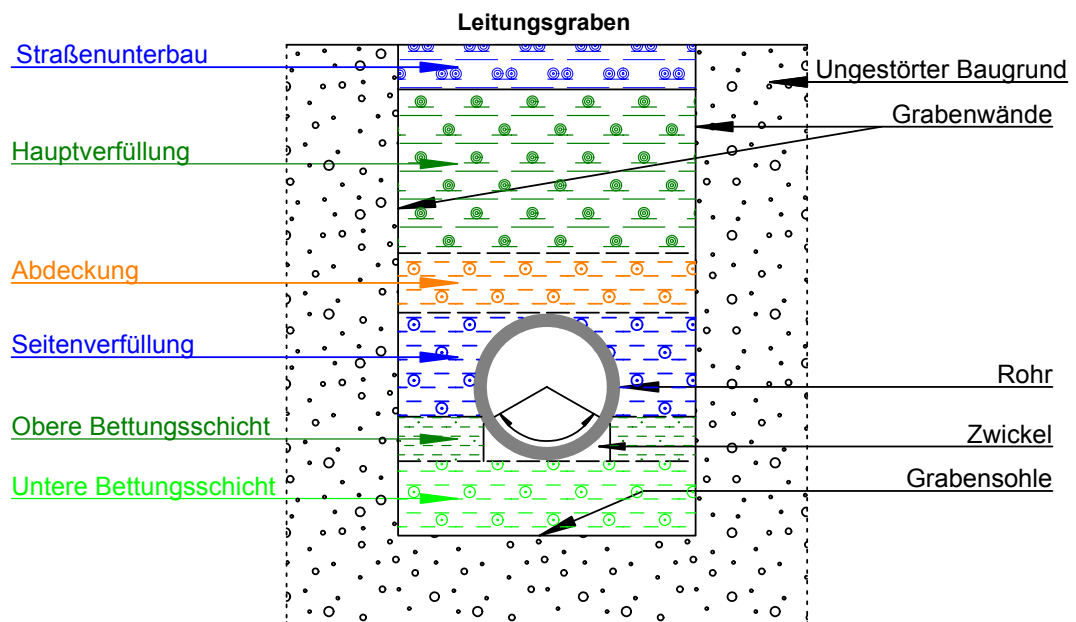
Baugrundzonen nach DIN EN 1610 [6]
